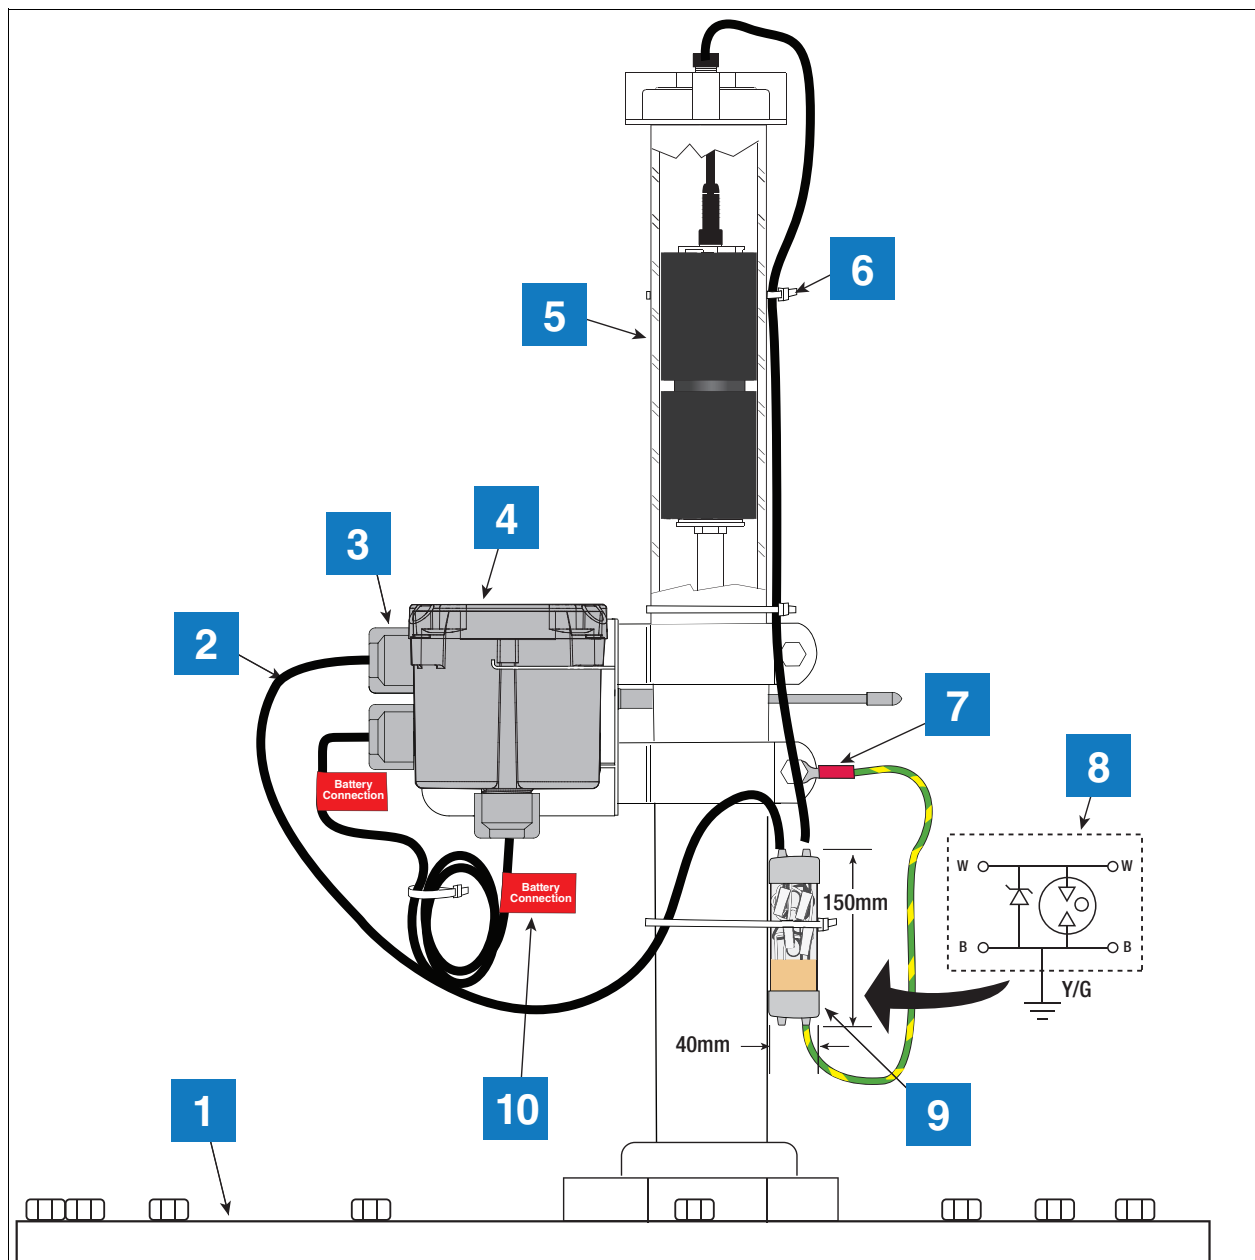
Esempio di installazione wireless con tubo riser e protezione da sovratensioni a canale singolo
